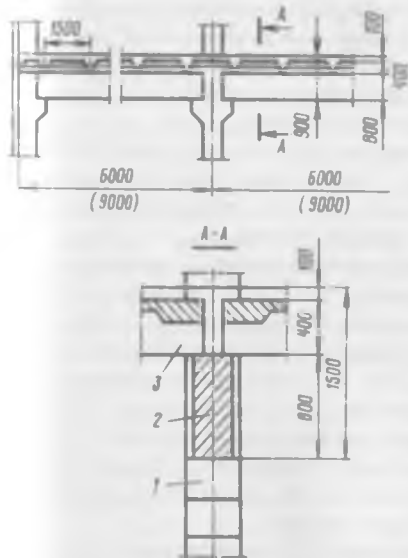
Сборное железобетонное перекрытие (тип I):
